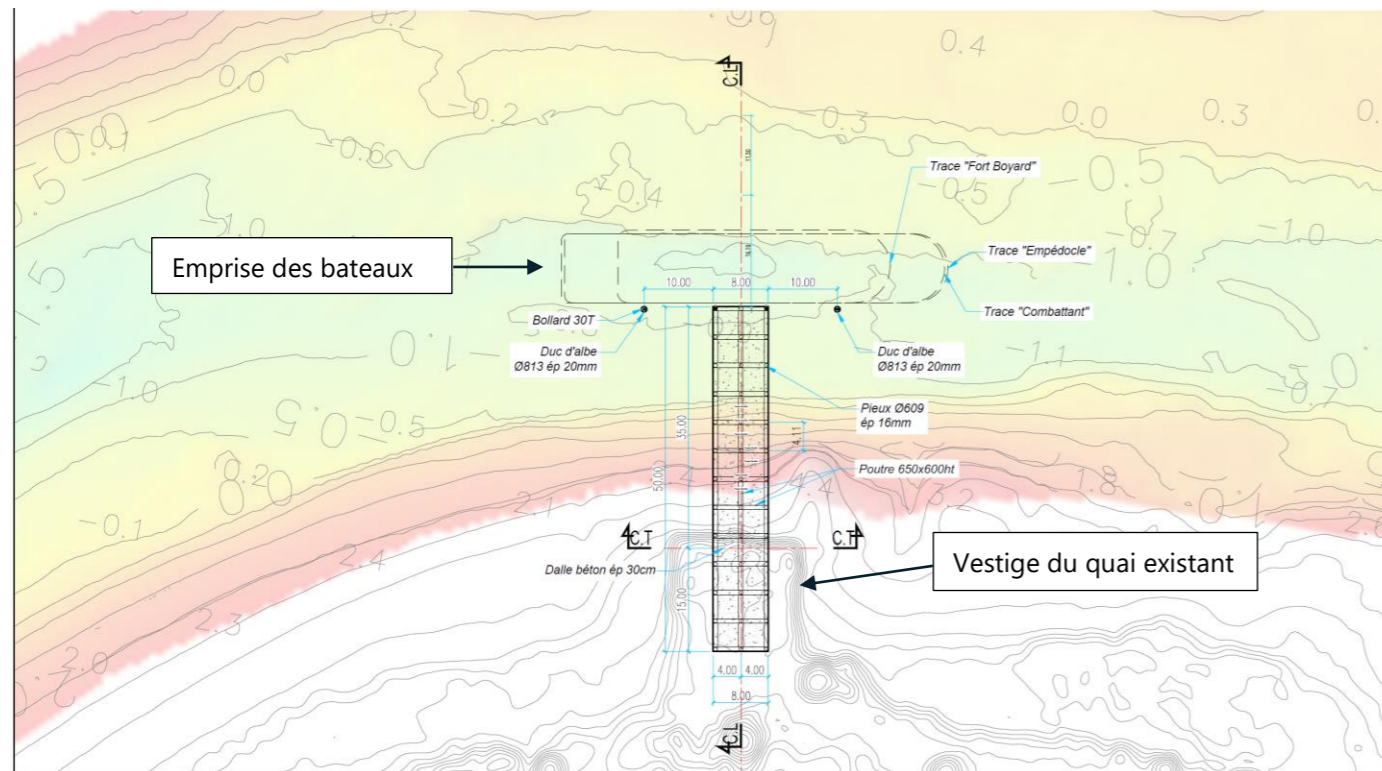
PLAN DE PRINCIPE DU PROJET D'APPONTEMENT (SOURCE : INGEROP – LORIENT AGGLOMERATION – ETUDE D'AVANT-PROJET SOMMAIRE - JANVIER 2021)
